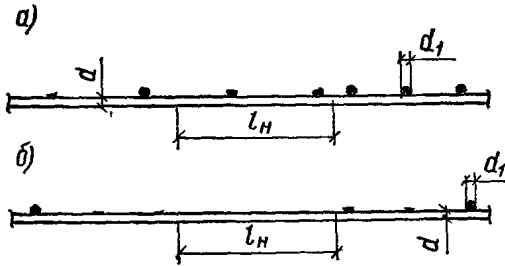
Стыки сварных сеток внахлестку (без сварки) в направлении рабочей арматуры при выполнении последней из стержней периодического профиля
